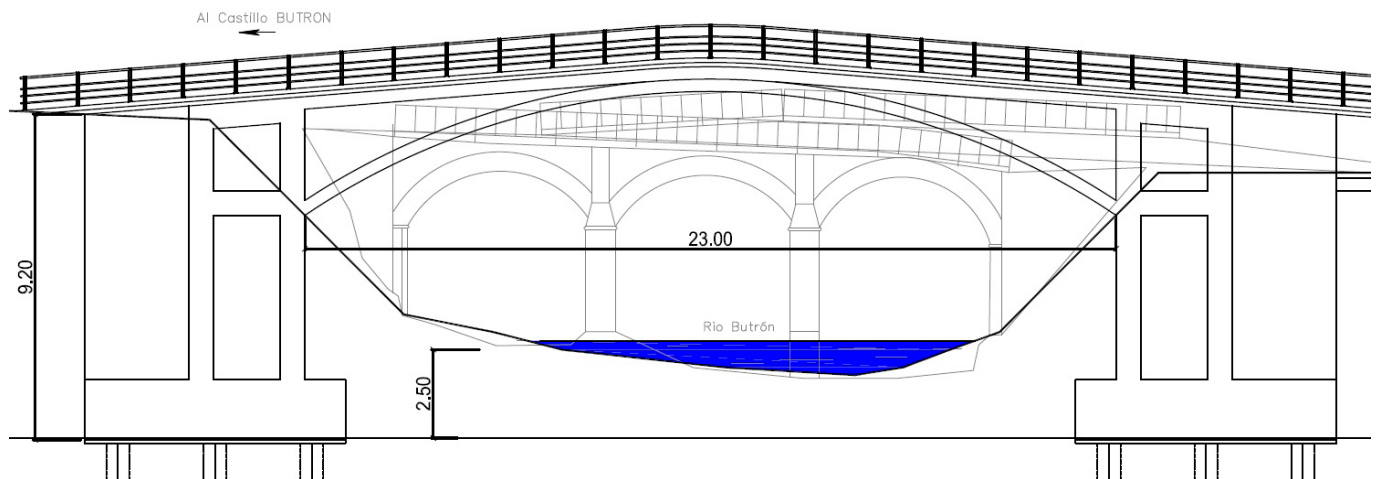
Alzado del proyecto constructivo inicial y superposición con puente original (trama gris).
